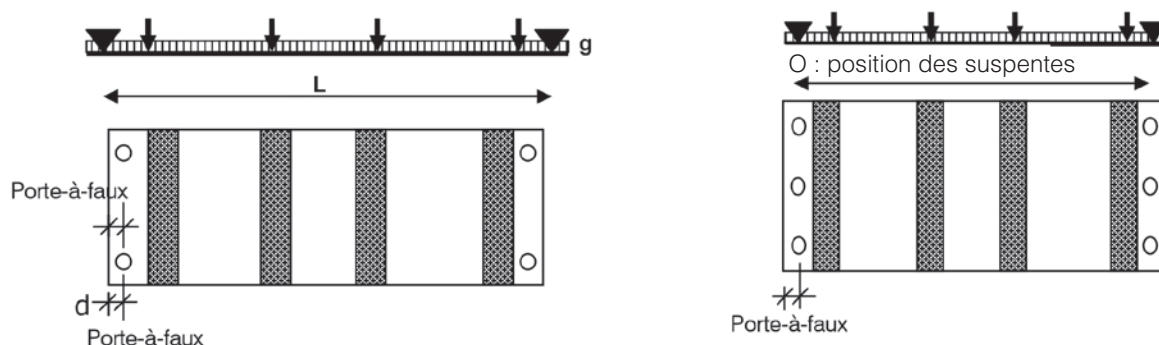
Essai (panneau sur 2 appuis) de flexion selon la norme NF P 34-503
